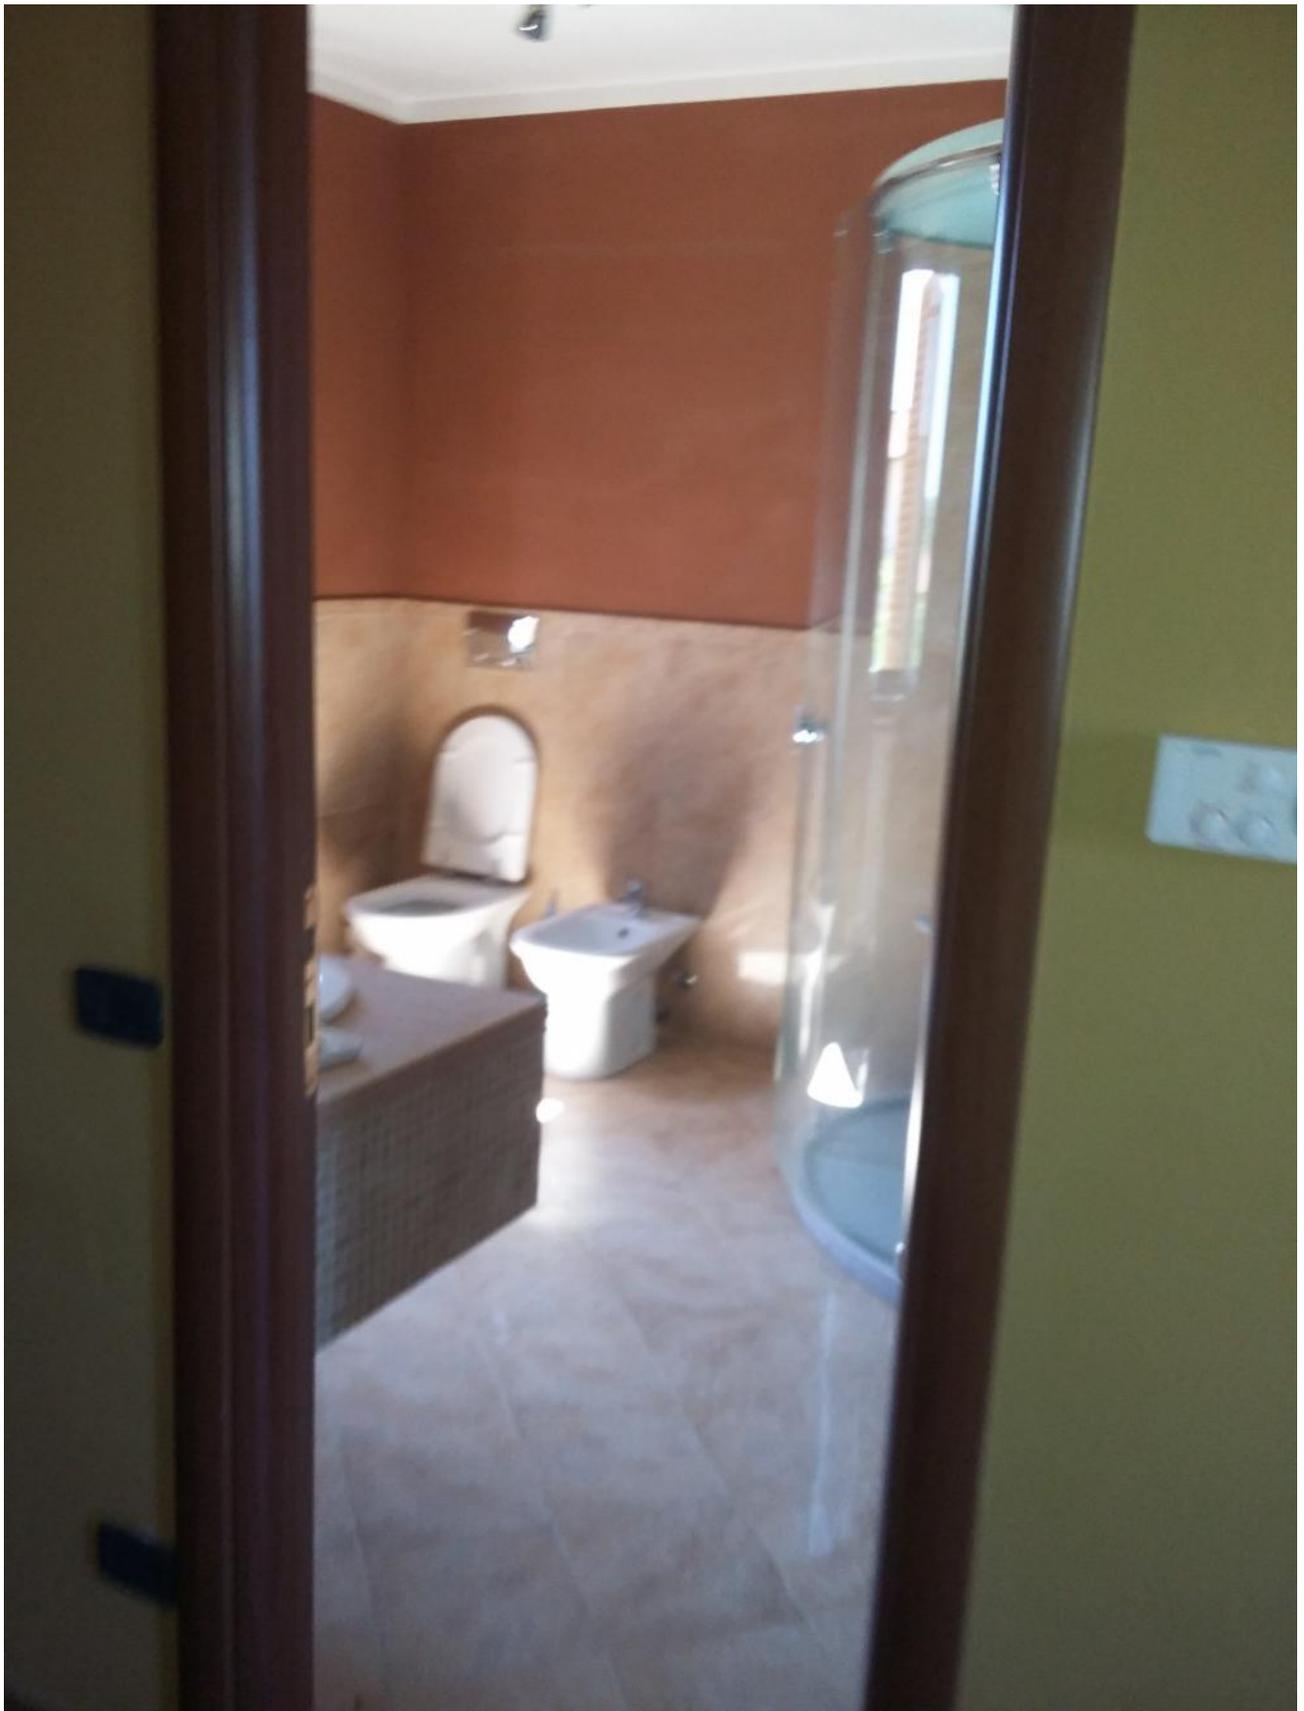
BAGNO IN CAMERA ZONA NOTTE NORD-EST; PIANO PRIMO
